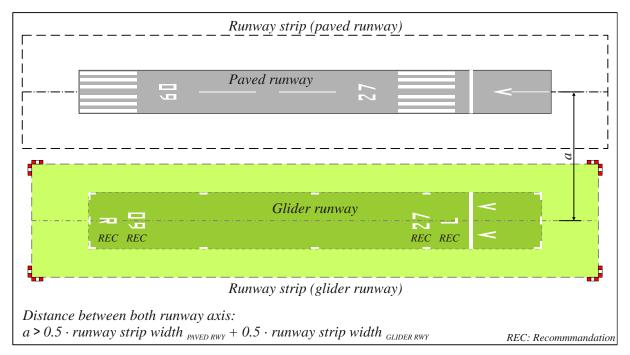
Piste planeur isolée ou piste planeur située hors de la bande de piste d'une piste revêtue
